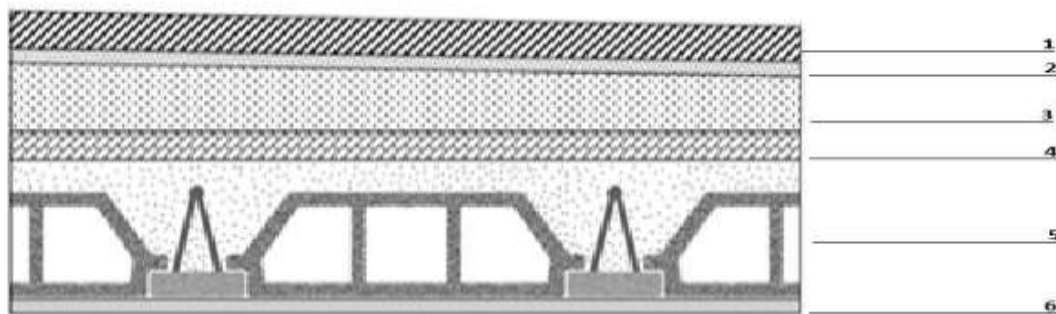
Coupe verticale du plancher terrasse à corps creux.
